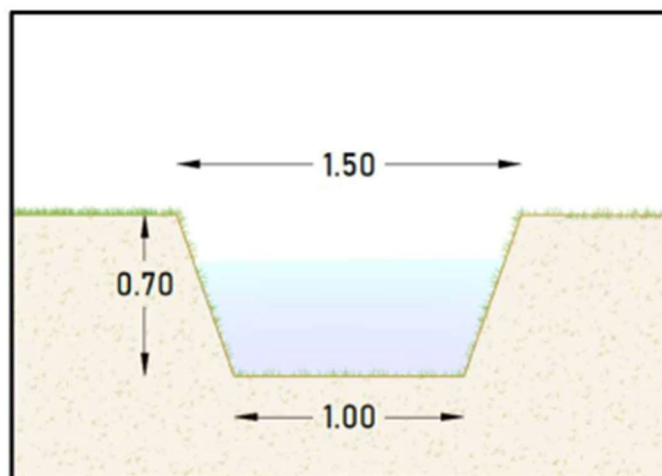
Sezione tipo canali di progetto interni ai lotti
